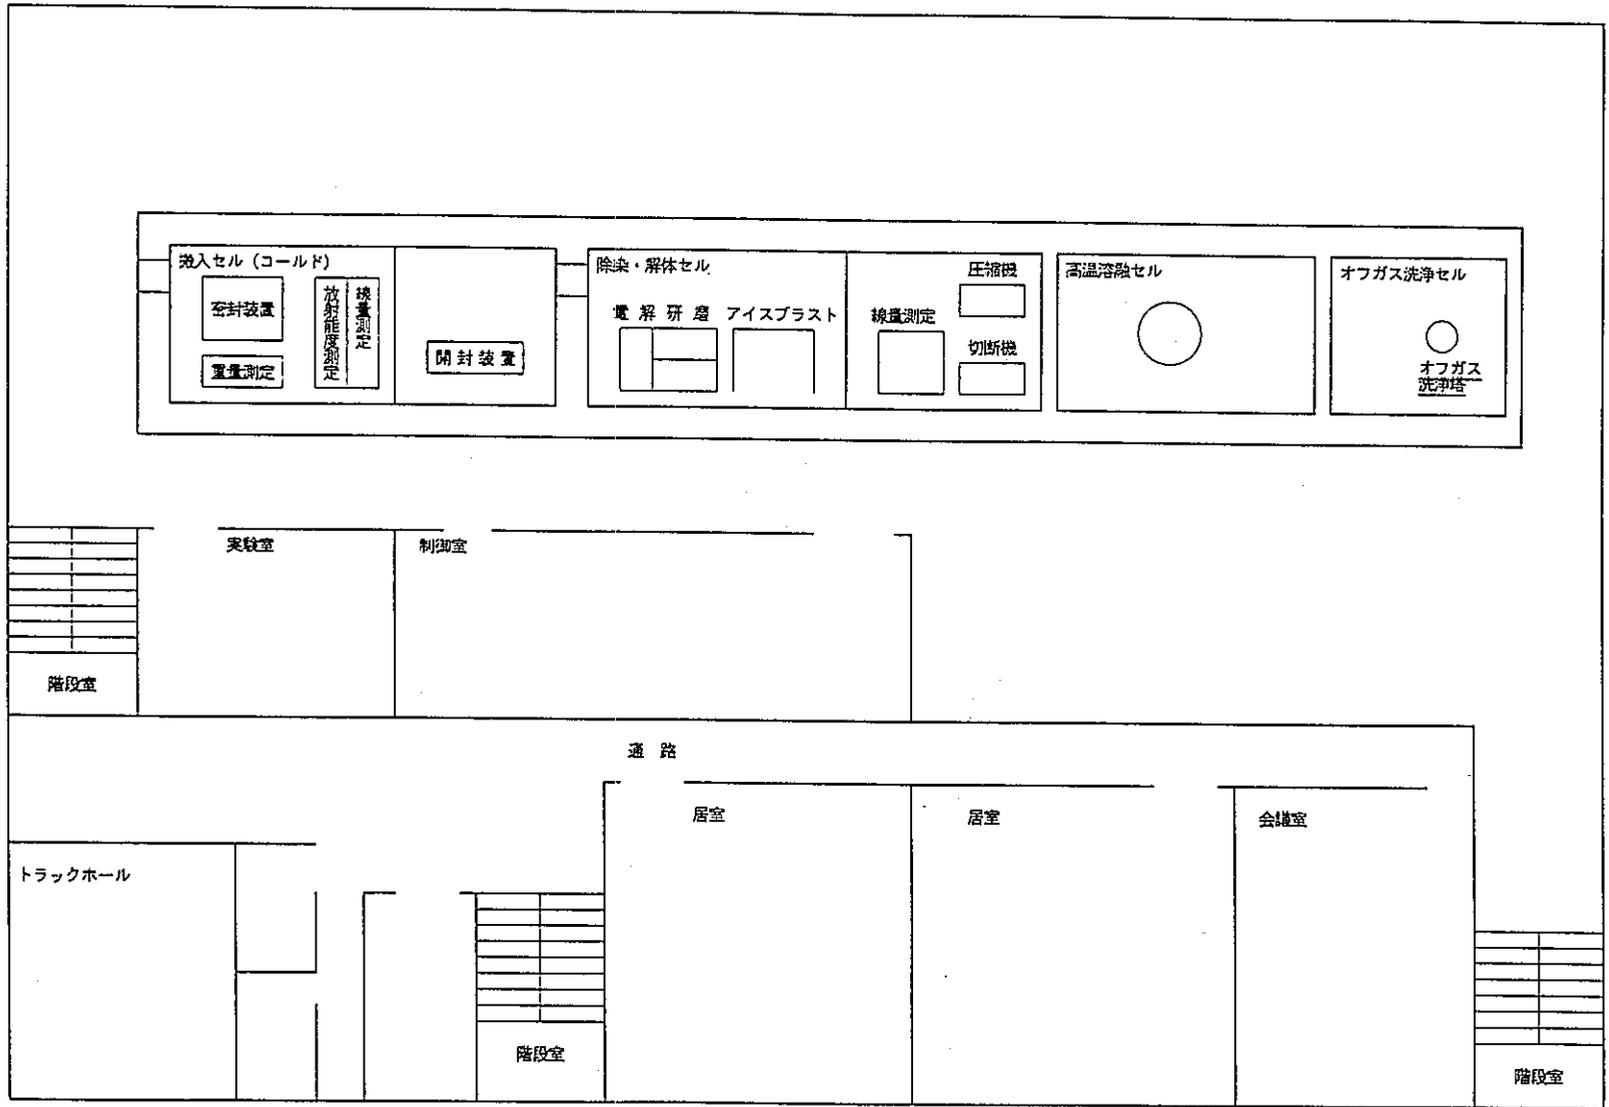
高レベルα固体廃棄物処理減容施設(2階)平面図(3/4)
